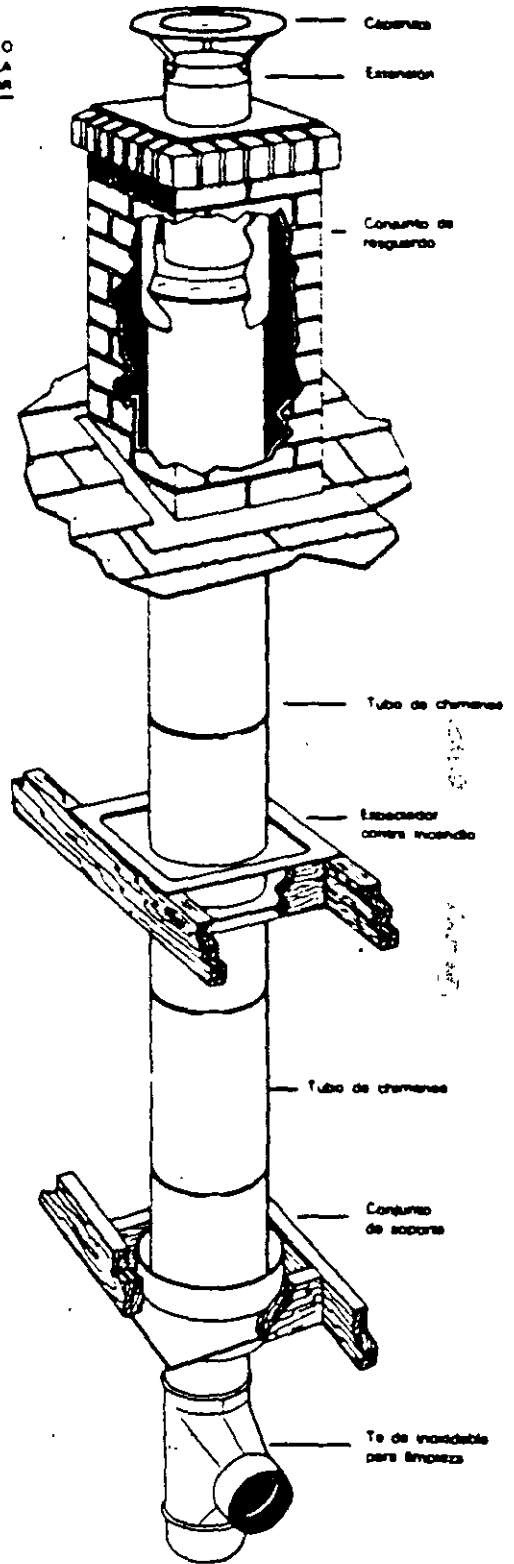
Chimenea construida en fábrica. (Cortesía de Metalbestos Systems, Wallace Murray Corporation.)
